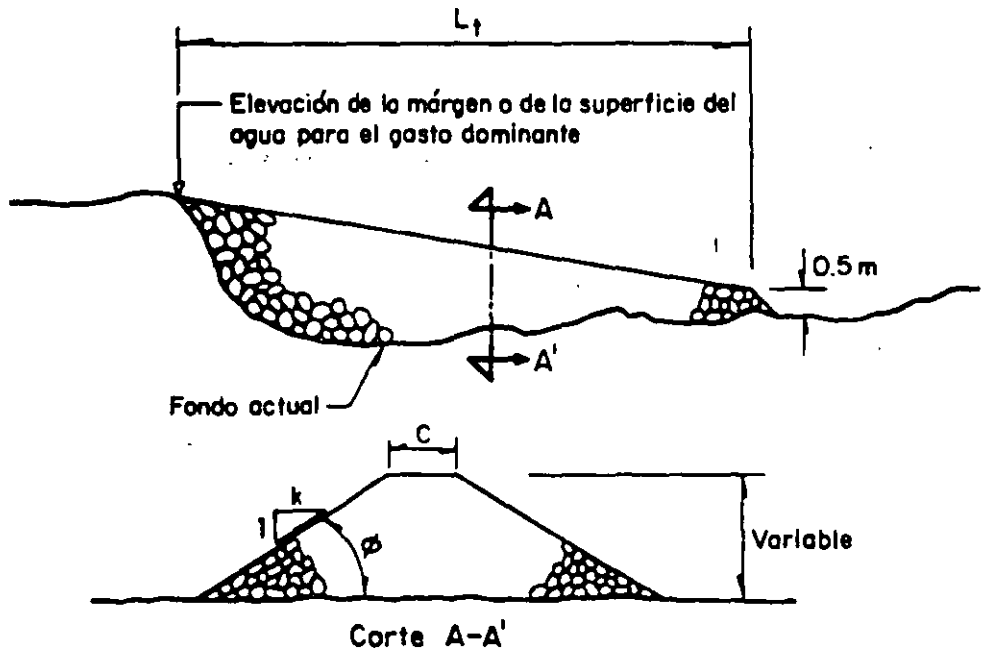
Espigón apoyado en la margen en ríos de planicie [6]
